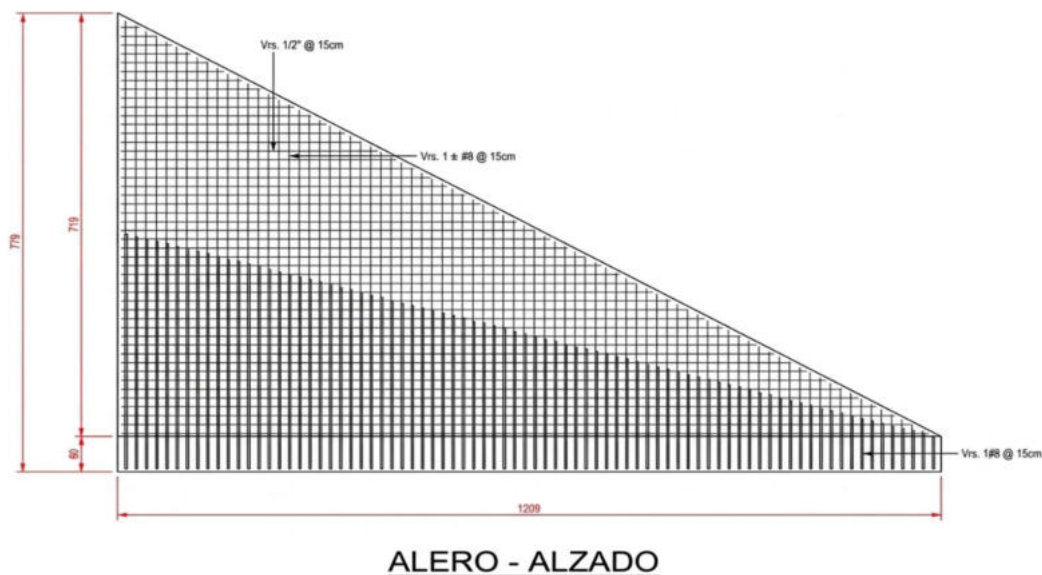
Detalle de alero del primer tramo. Nota. Elaboración propia.
